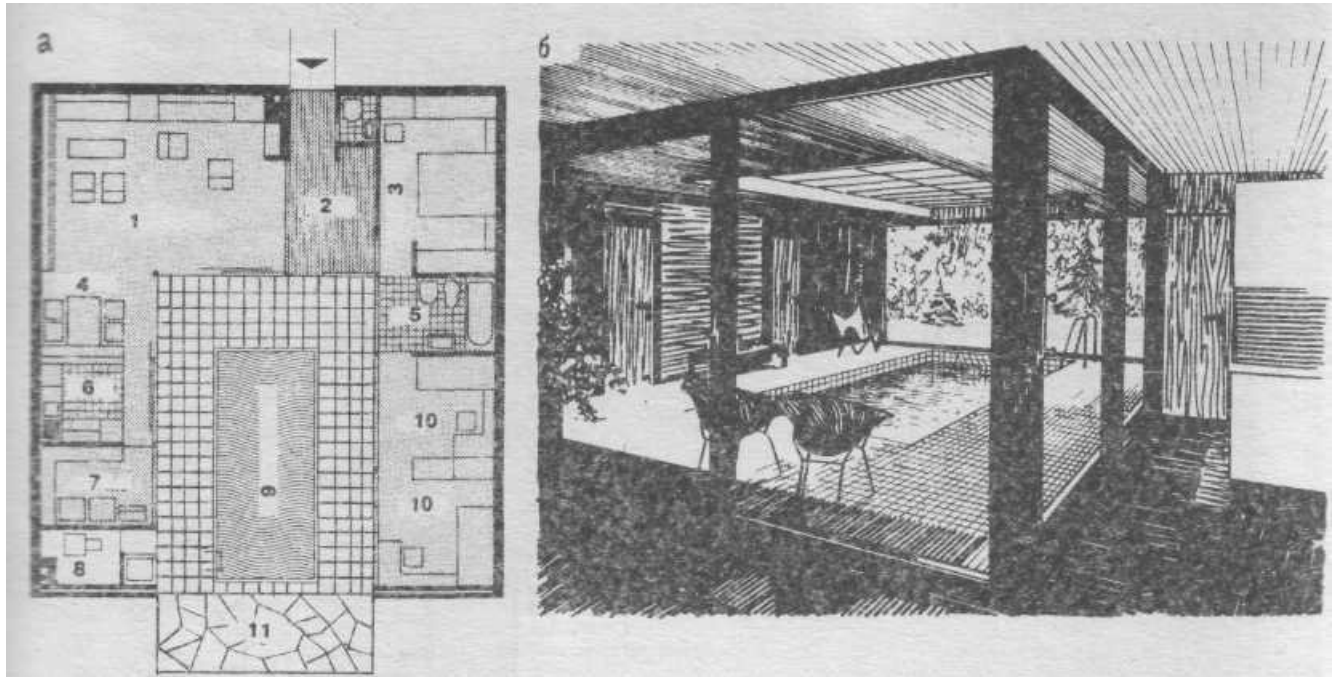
В небольшом жилом доме (жилая площадь 98,5 м²) плавательный бассейн размещен в крытом дворике, имеющем оаздвижное плексигласовое покрытие над бассейном и стеклянные раздвижные двери с южной стороны. Жилые и спальные помещения освещаются через узкую сплошную полосу верхнего остекления. Слишком глубокий для своей площади бассейн (2,75 x 6,26, глубина 2 м) вписан в дворик, обходная дорожка служит местом для передвижения во дворике. Большой объем воздуха в помещении по сравнению с площадью бассейна (практически весь дом является бассейном) вместе с вентиляцией через окна и перманентной вентиляцией через покрытие позволяют в данном случае отказаться от вентиляционного оборудования, причем влажность воздуха находится в пределах 50 -60% (больше зимой, меньше летом). Архитектор А. Оберлак. Шилдген
